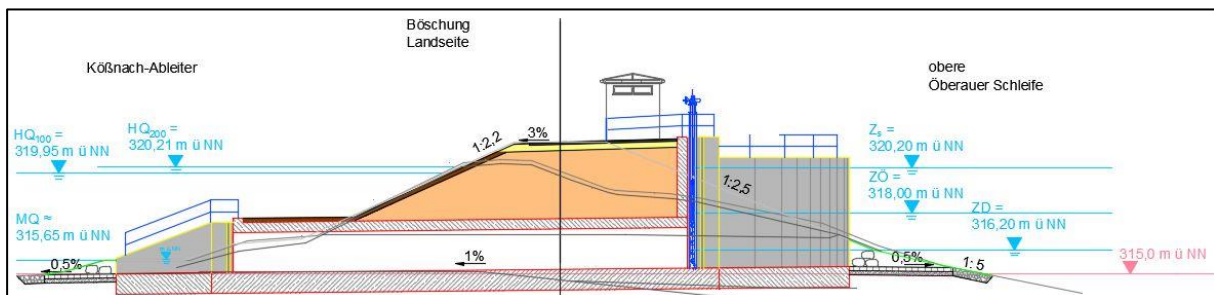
geschlossene Bauweise mit in den Deichkörper integrierten Durchlässen
